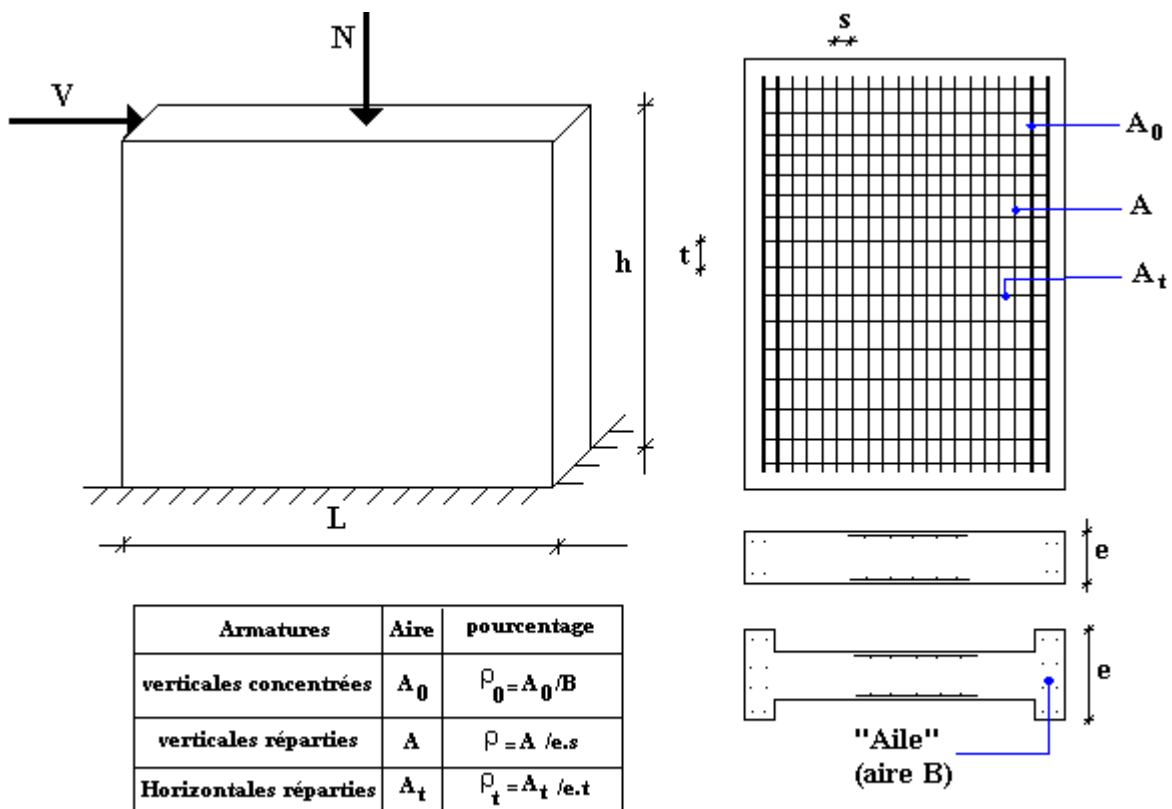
Schéma d'un voile plein et disposition du ferrailage.
